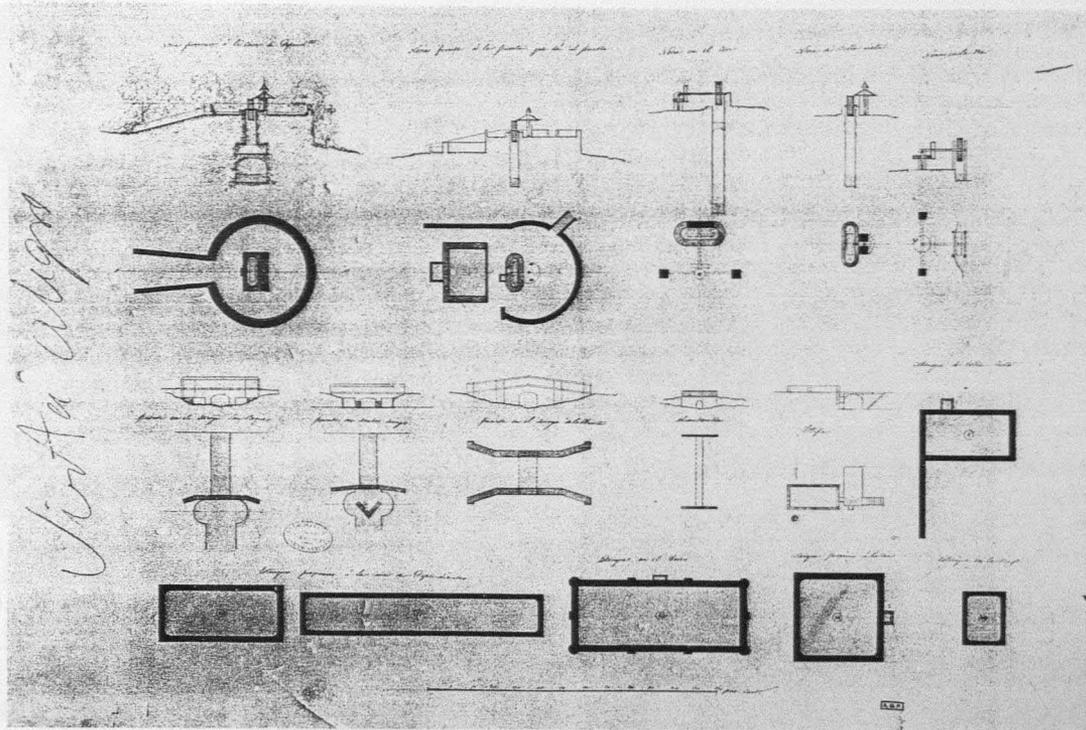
Plantas y alzados de norias, puentes, estanques, alcantarilla y estufa de la finca (cartulina a tinta china y color a la aguada, 573 por 826 mm. Escala: gráfica en pies castellanos). Sección planos, nº 3.519, A.G.P., Madrid.
